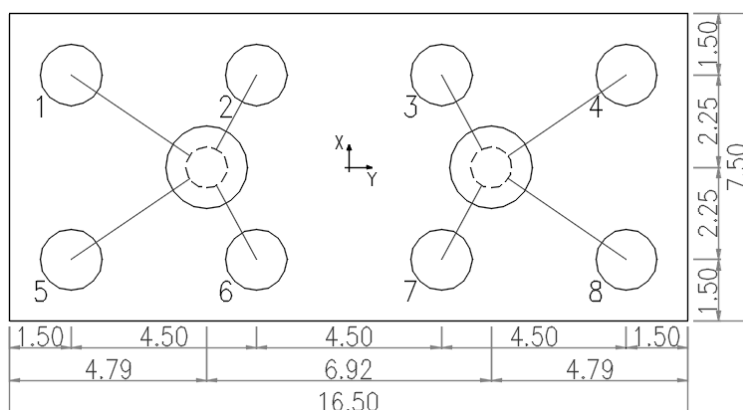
Modelo de bielas e tirantes em planta
